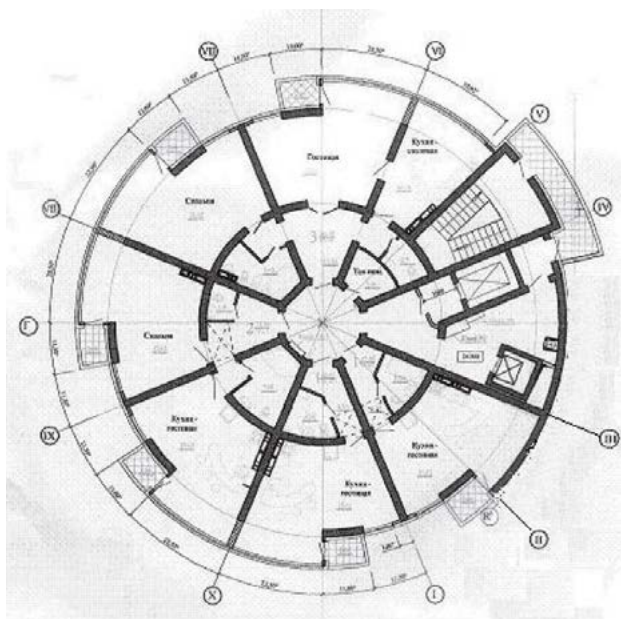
План типового этажа 23-этажного здания в Ялте
